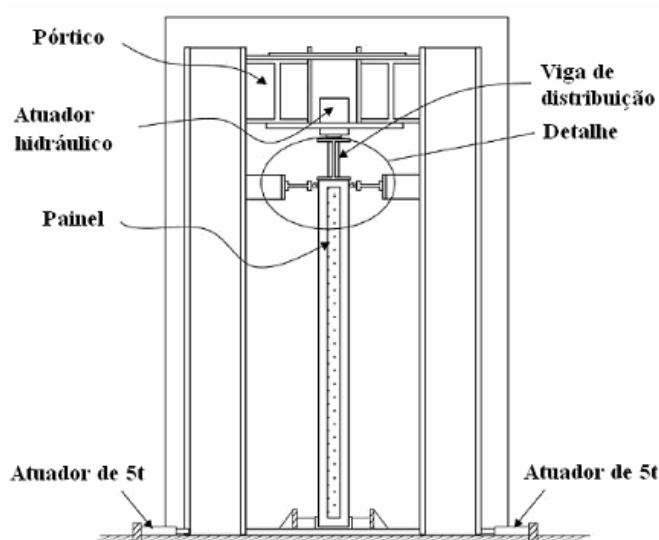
Arranjo experimental de ensaios em painéis sanduíche
